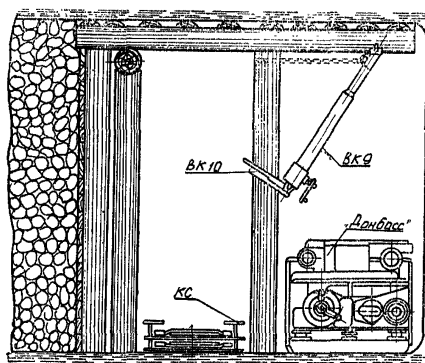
Схема установки стойки ВК-9 для поддержания консоли верхняка
